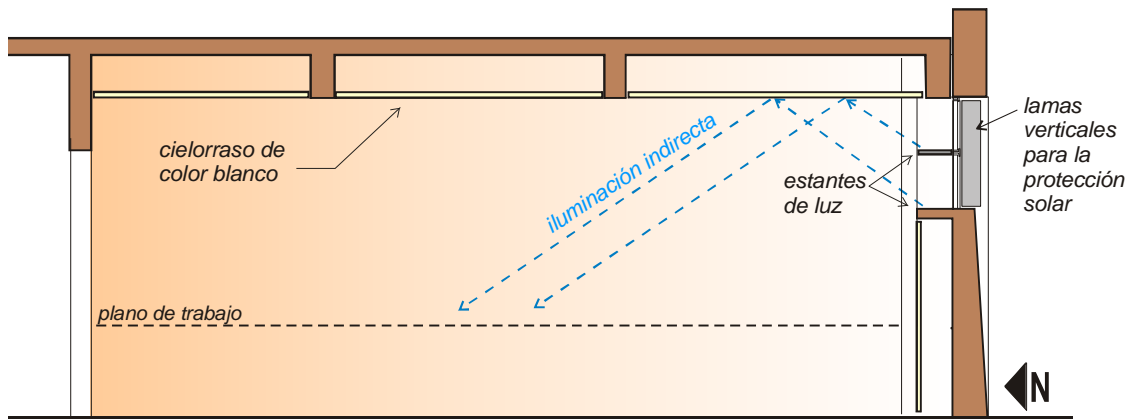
Propuesta de aventanamiento para el frente Sur (oficinas FACEyT).
